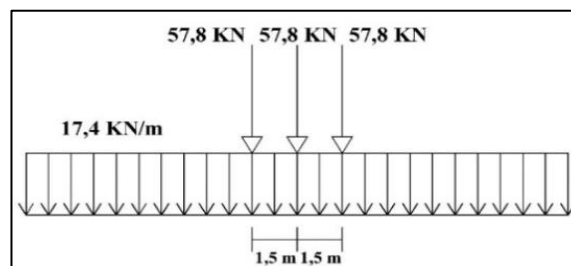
Composição do veículo tipo simplificado para as vigas extremas.
